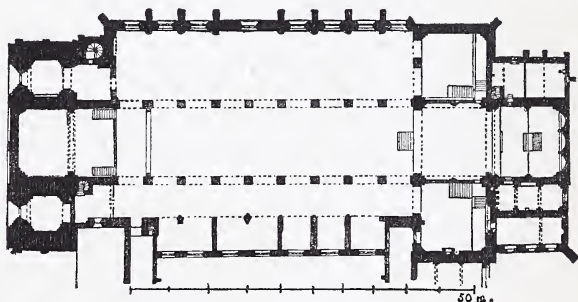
Grundriss des Domes zu Bremen.
